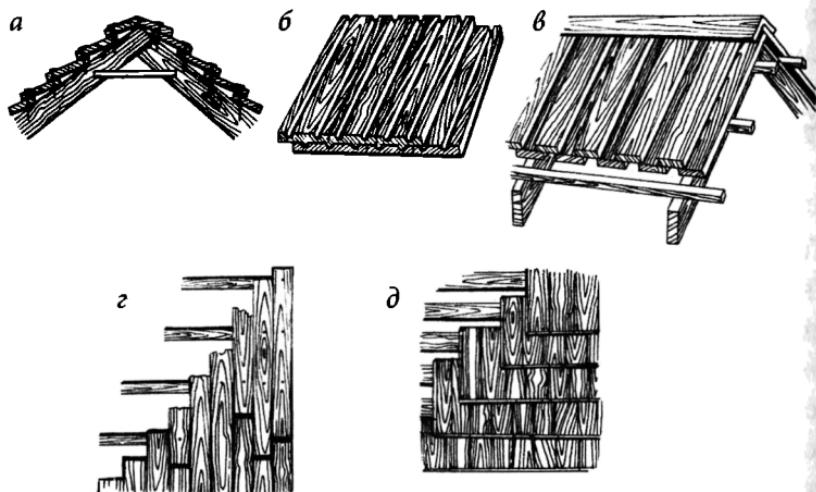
Деревянные кровли: а) тесовая внахлестку; б) тесовая двухслойная; в) общий вид тесовой кровли вразбежку; г) драночная; д) щепеная
